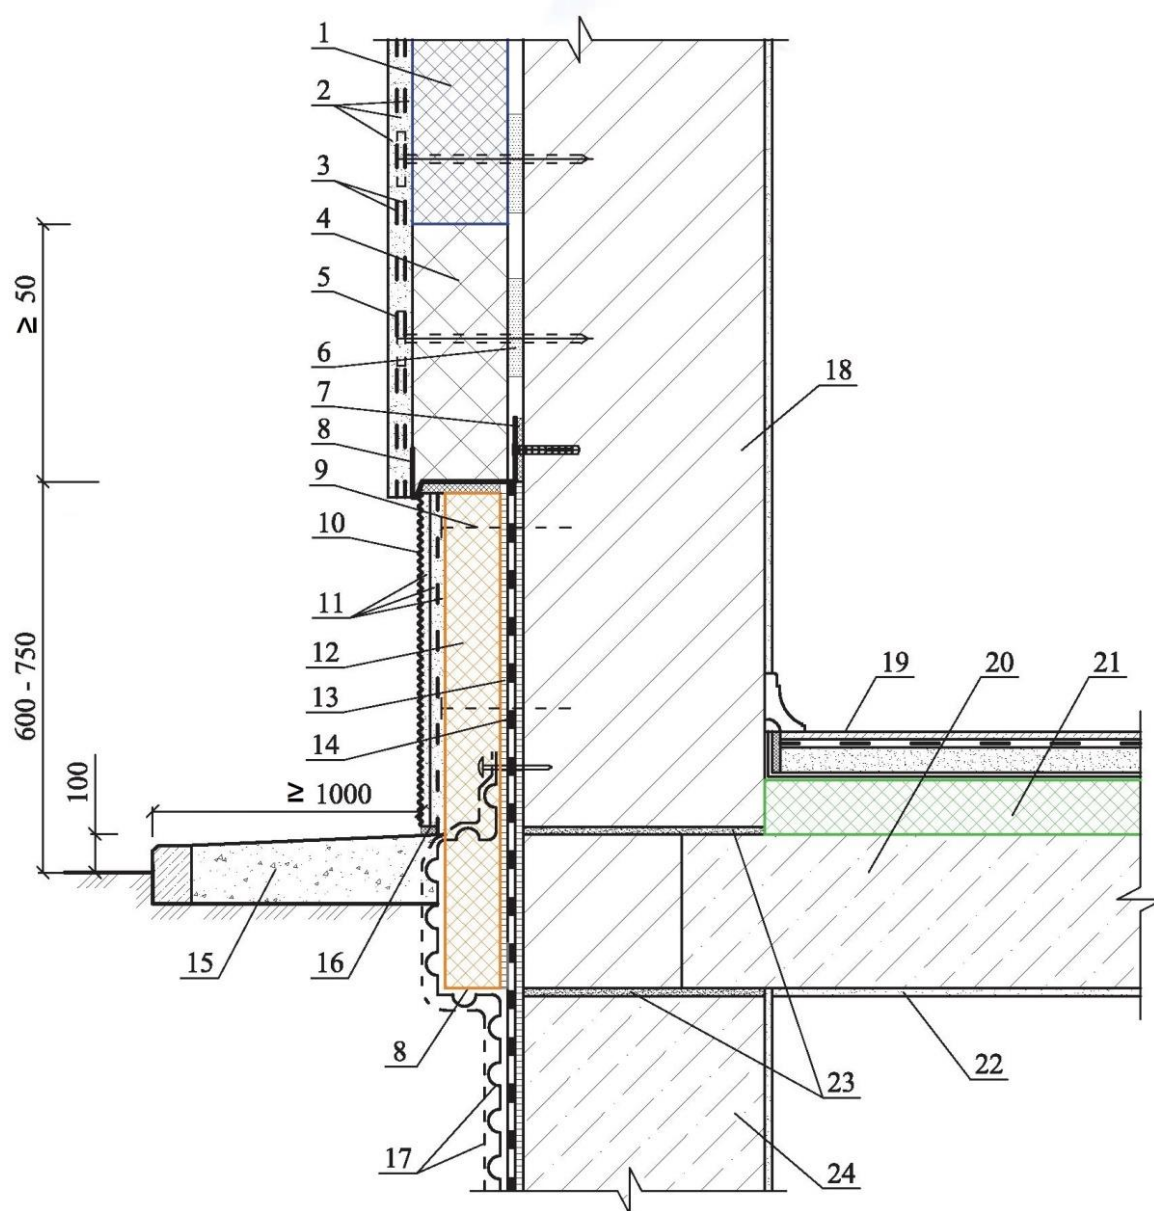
Стіна неопалювального підвалу перекриттям над підвалом на рівні землі: 1 - теплоізоляція з пінополістирольних плит графітовмісних (марок
